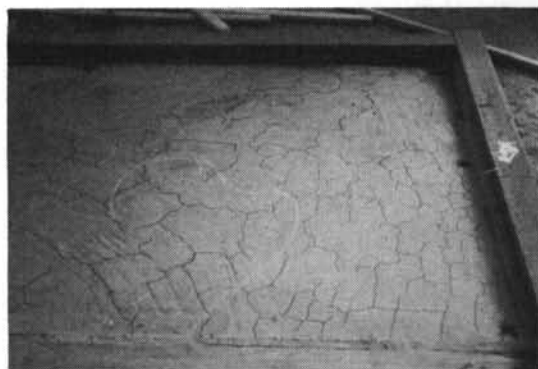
気泡コンクリートに生じた亀甲状の亀裂
